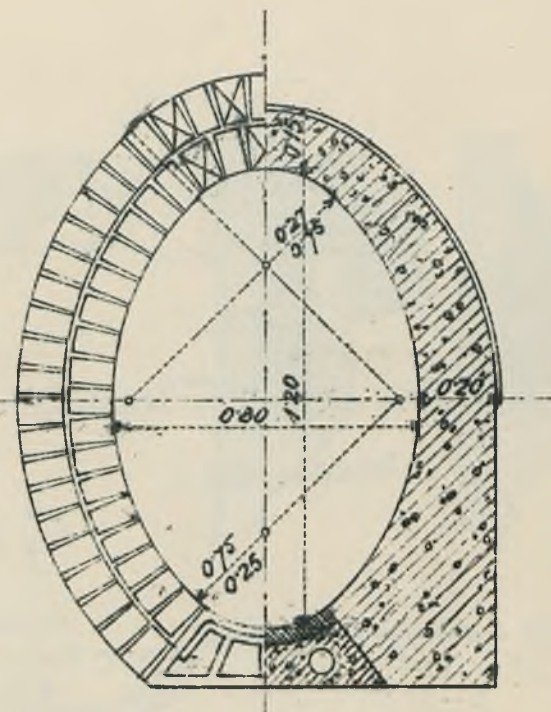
Kanał suwalny wzniesiony z cegły - łok. betonowy z warstwą wyprawy z resztek ceglastego
